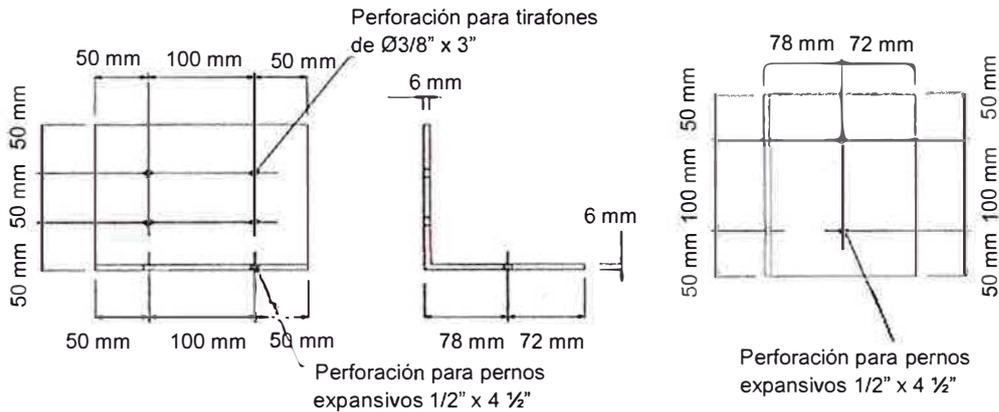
Detalle de perfil de fijación de módulo a cimiento
